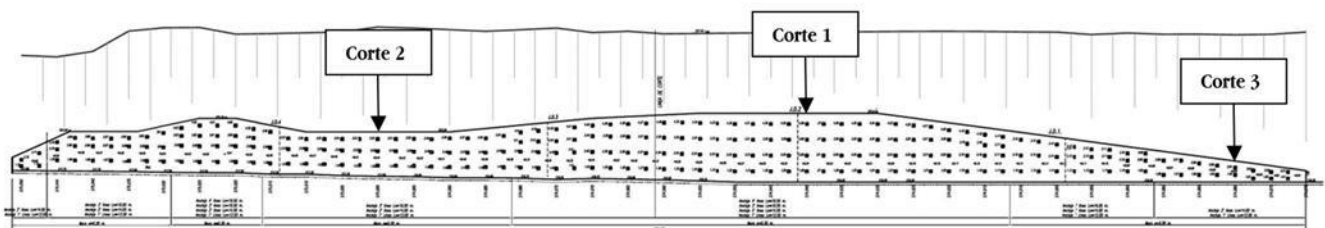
Vista Frontal en elevación del muro y ubicación de cortes
